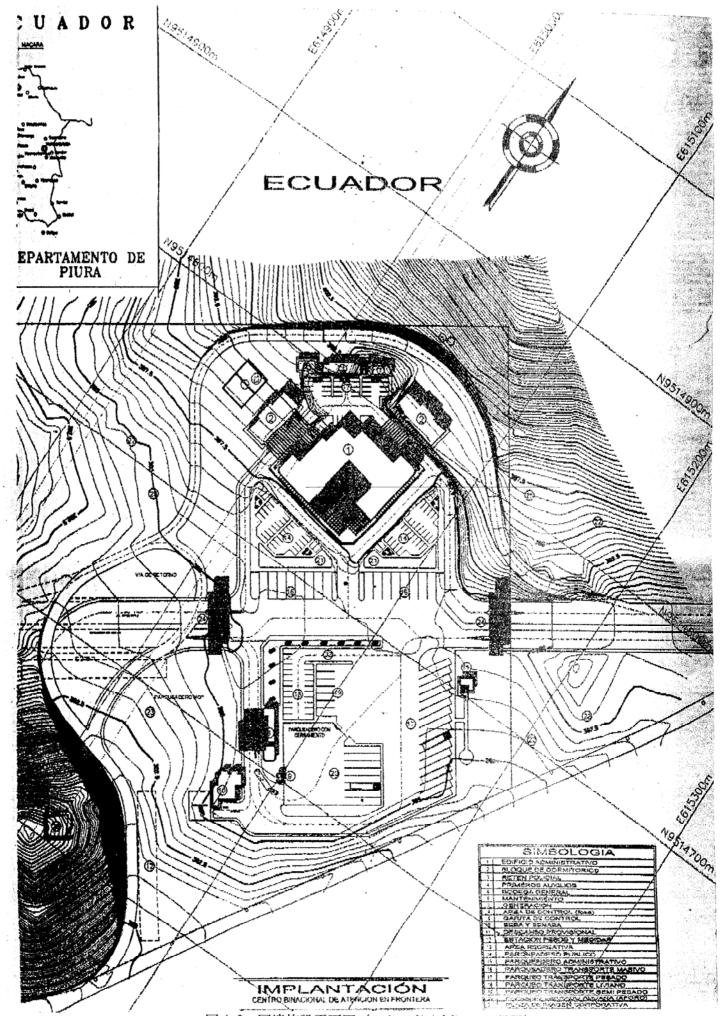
国境施設平面図 (エクアドル側にのみ設置)
